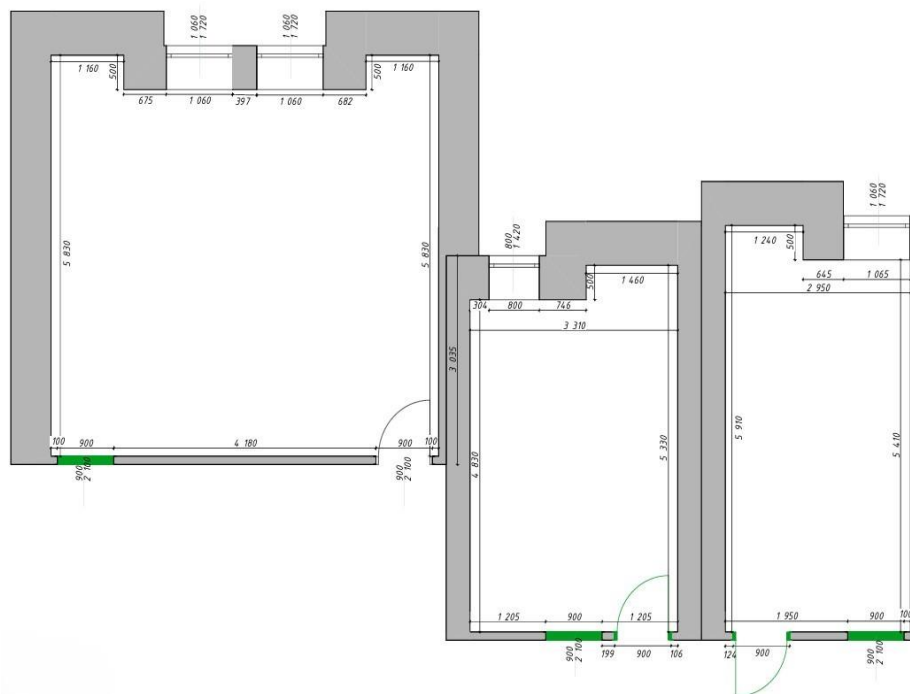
Схема плану монтажу для усіх кімнат
